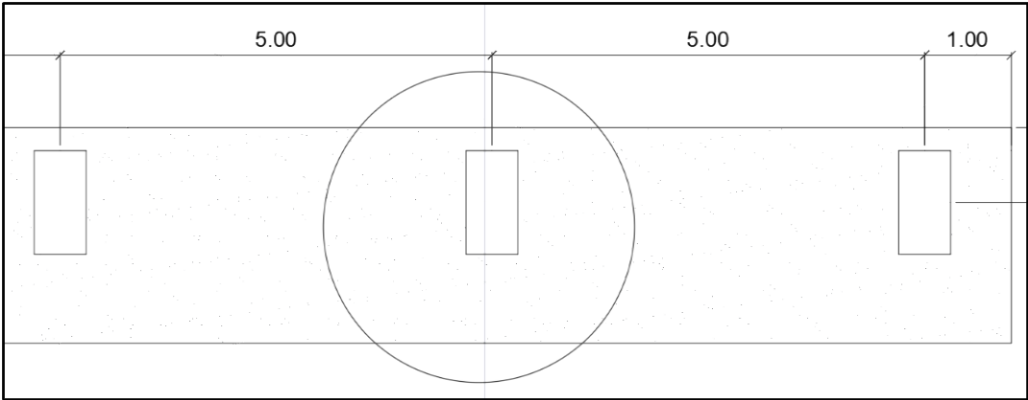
Dimensiones de la zapata [Pelayo & Ashby, 2020]
